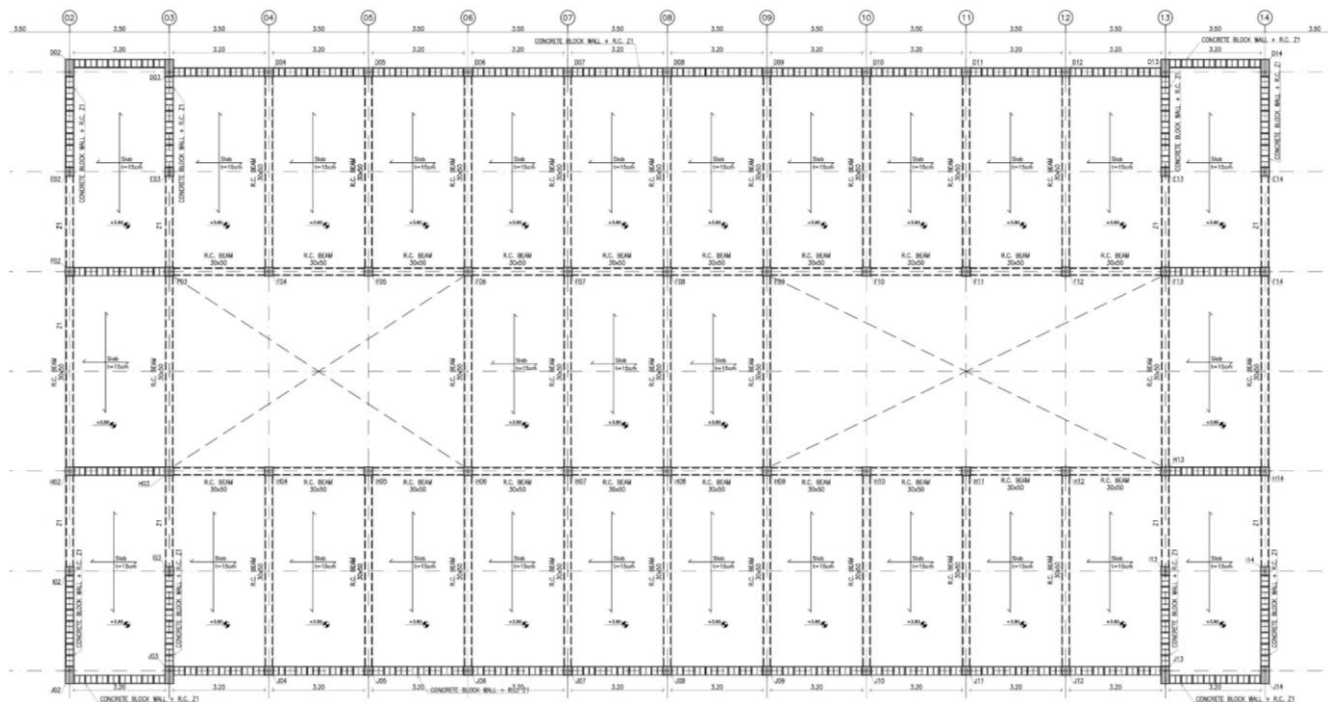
Planta edificio tipo (National Emergency Treatment Center)
